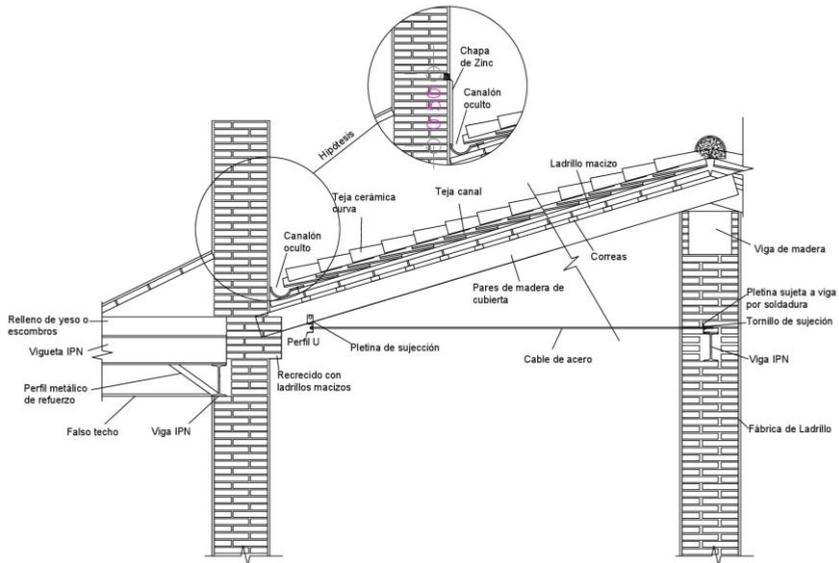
Detalle de cubierta. 2018. Fuente: Propia
